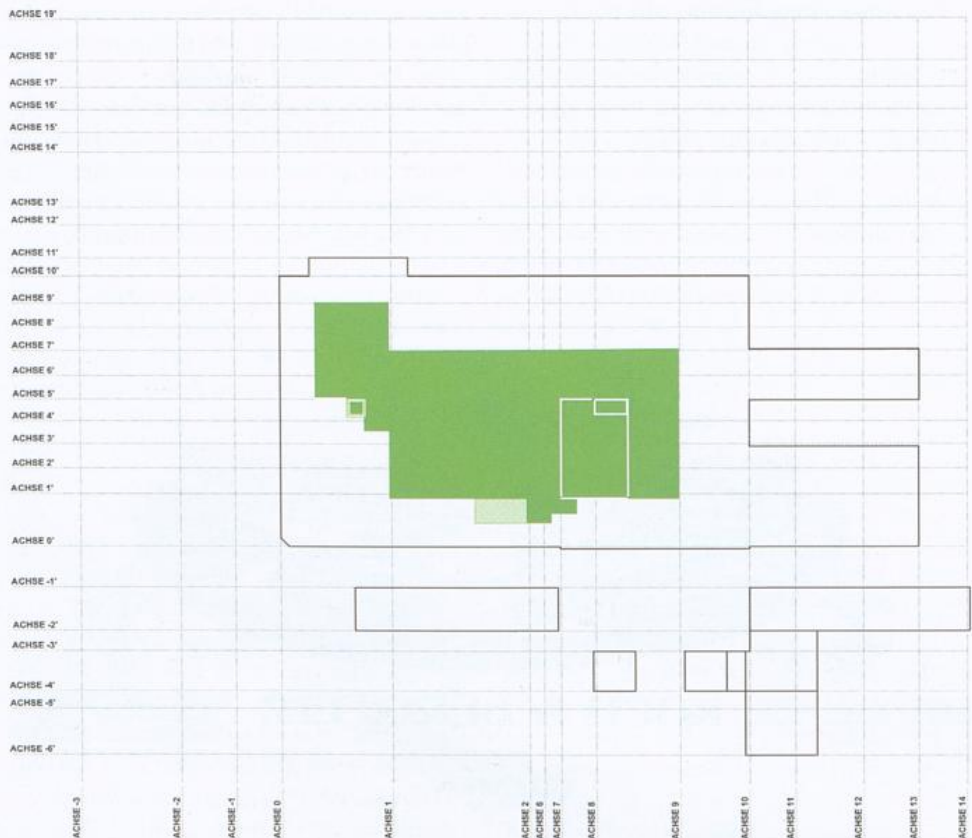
Lageplan der Silberwarenfabrik Koch & Bergfeld – heutiger Umriss (schwarz) mit Eintragung des 1874 erbauten Ursprungsbaubestands (grün)
